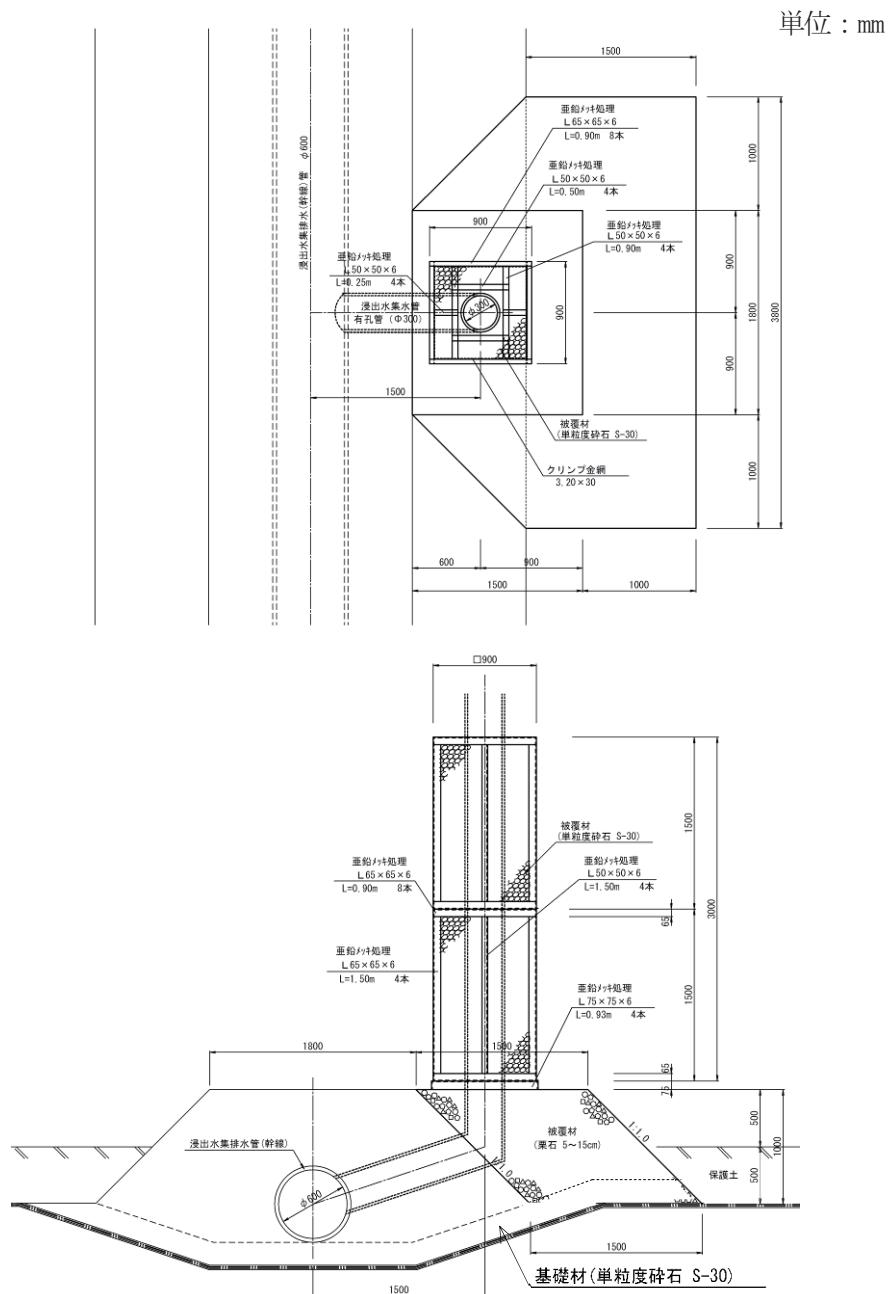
6-27 壓型浸出水集排水管 標準平面図・断面図
